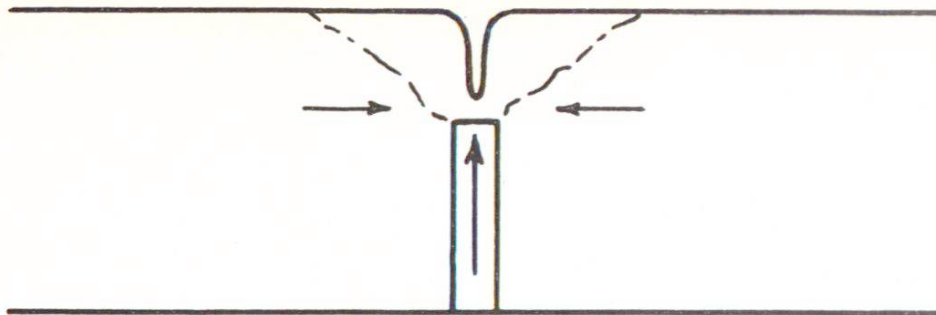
et b Mauvaise position du joint d'un revêtement bétonné le long d'un mur à semelle. Rupture lors de mouvements verticaux par tassement ou gonflement du sol. (voir aussi fig. 5)
